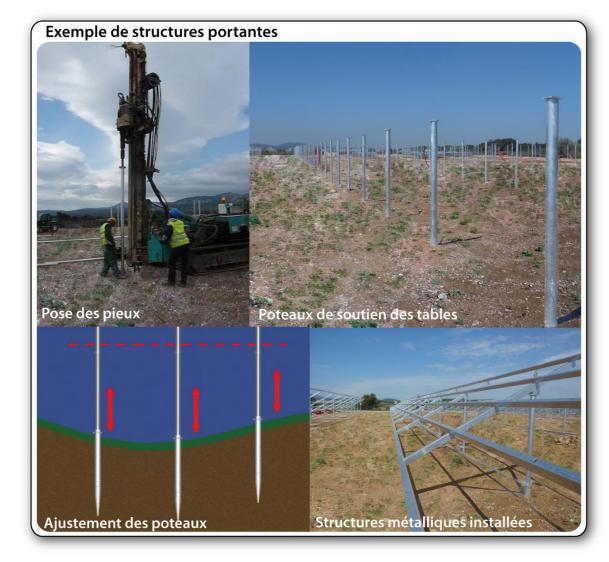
Exemples d'installation de structures (Source : MELVAN)
